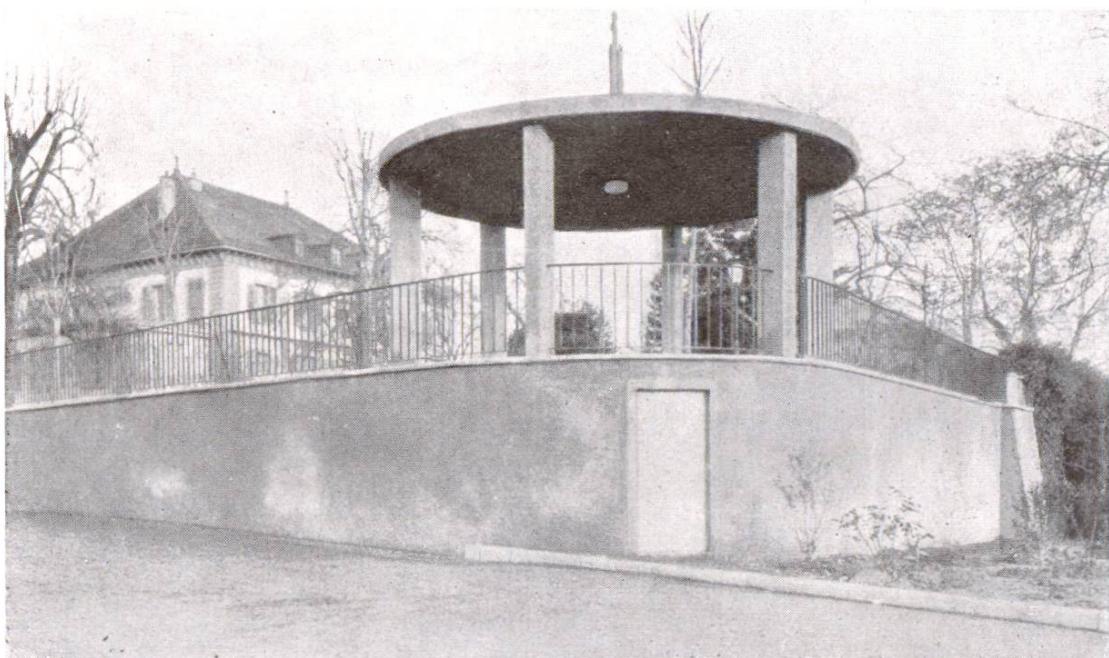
Mur de soutènement et pavillon de l'auberge du Vieux Bois à Prégny/Genève
